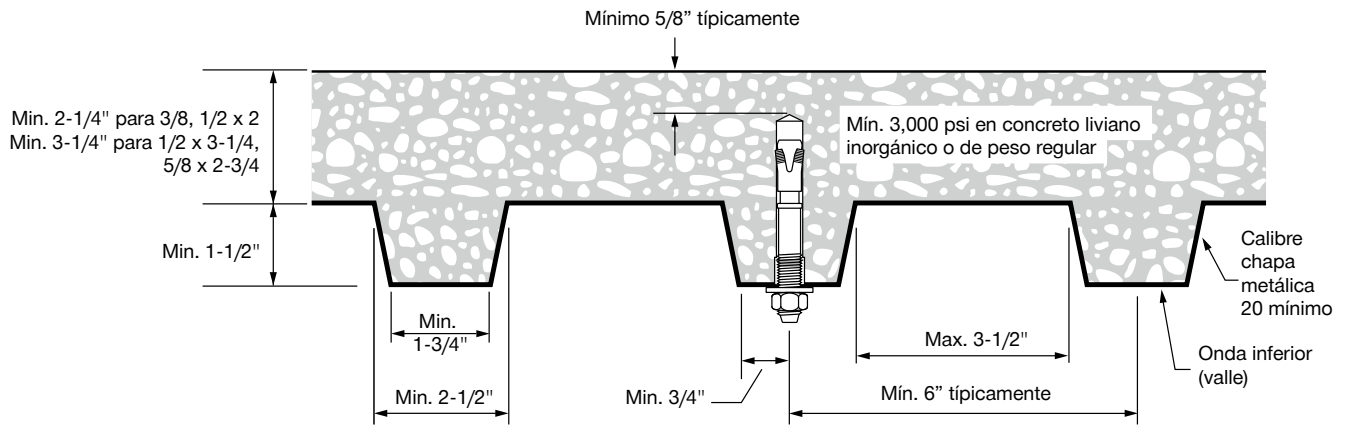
Instalación de Kwik Bolt VTZ sobre concreto liviano inorgánico en el piso de una chapa metálica en losa compuesta
